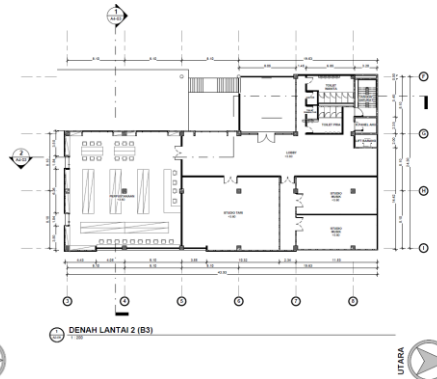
Layout Lantai 2 (Massa Bangunan 2)
